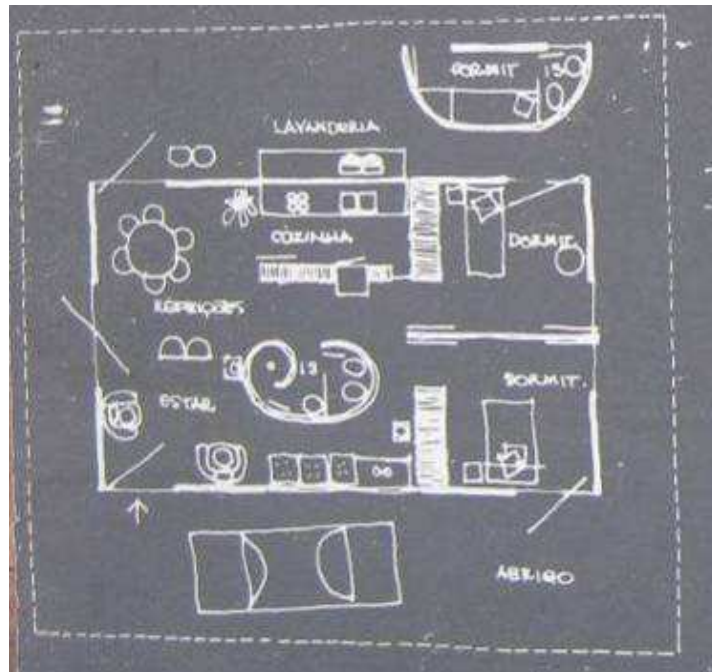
Residência Família Assad: Croqui realizado pelo arquiteto Abraão Assad.
